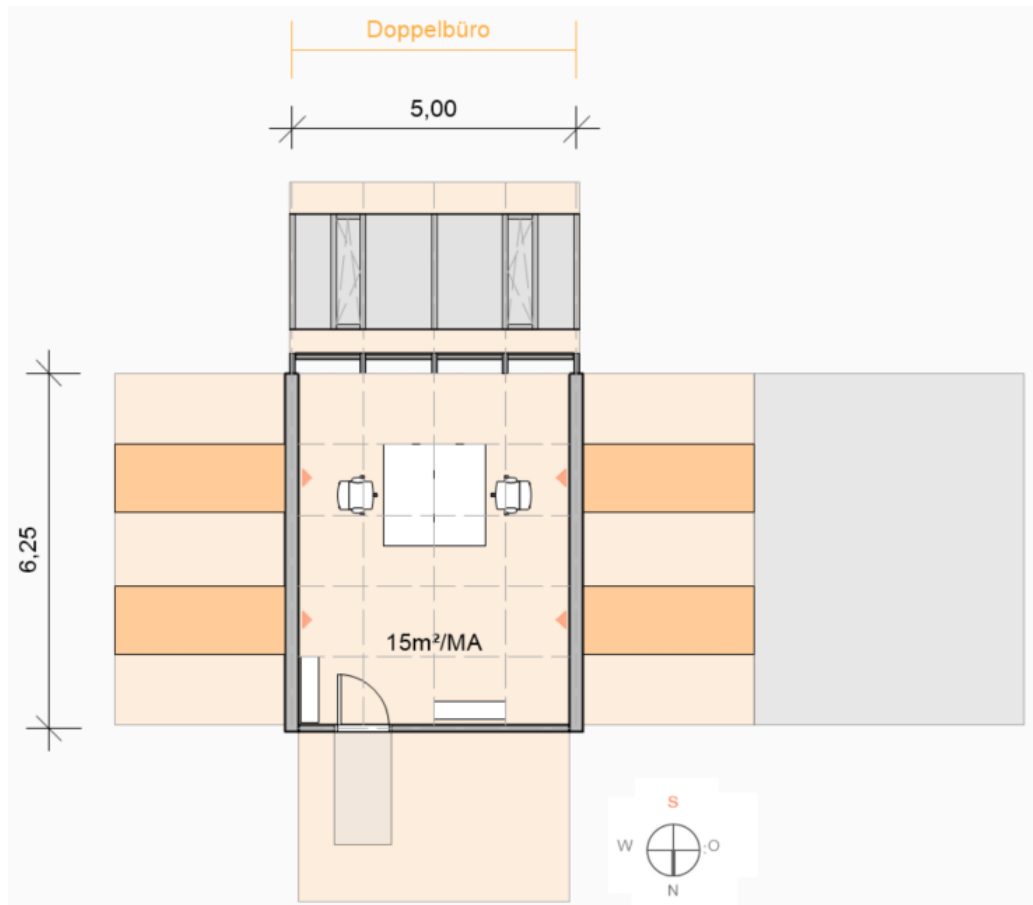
Doppelbüro mit ca. 30 m² Grundfläche, vollverglaster Fassade mit außenliegendem Sonnenschutz, vier thermisch aktivierte Massivholzelemente
